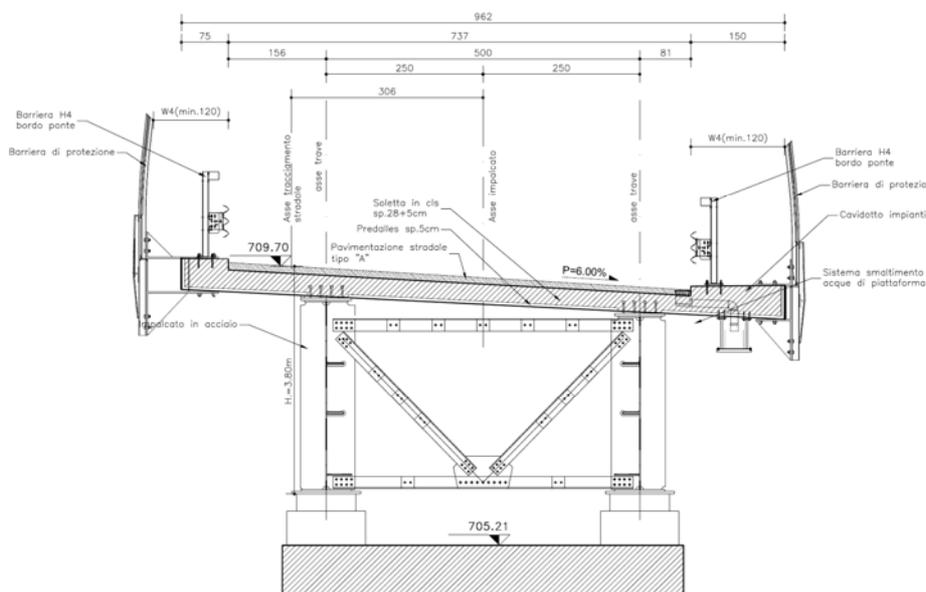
Viadotto Allargamento Discesa – tratto disgiunto – sezione su Pila IP1
